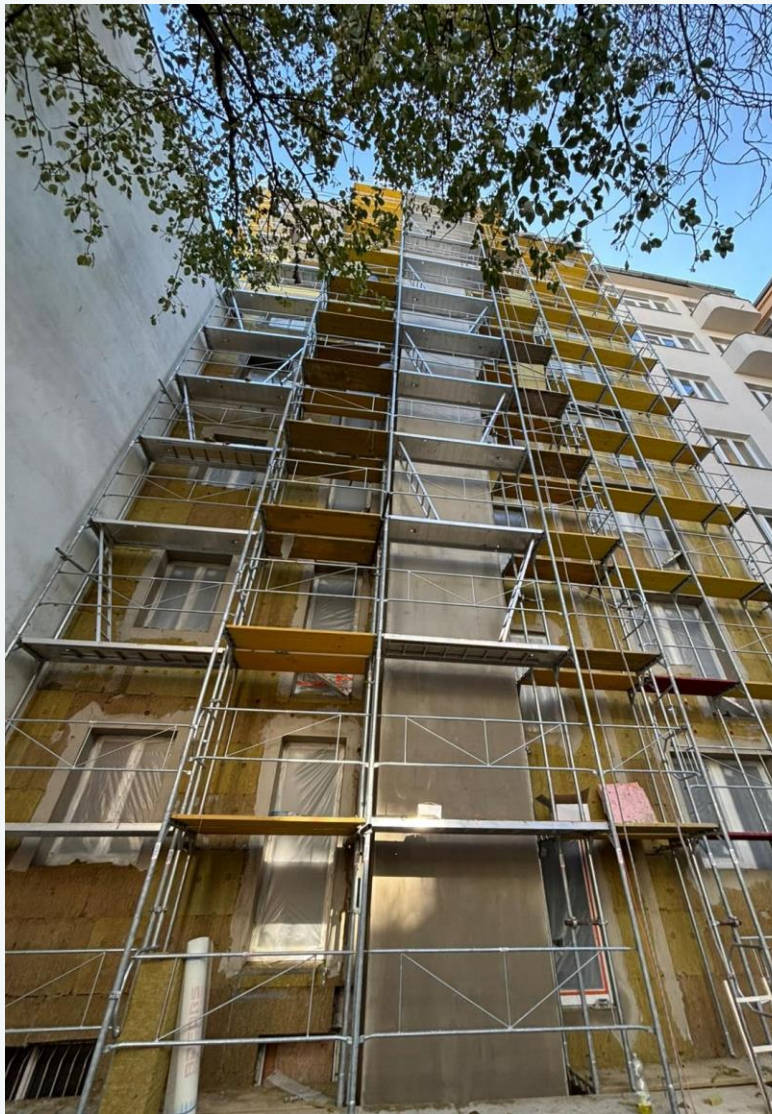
FOTO ZE STAVEB – ZAHRADY STRUHAŘOV
